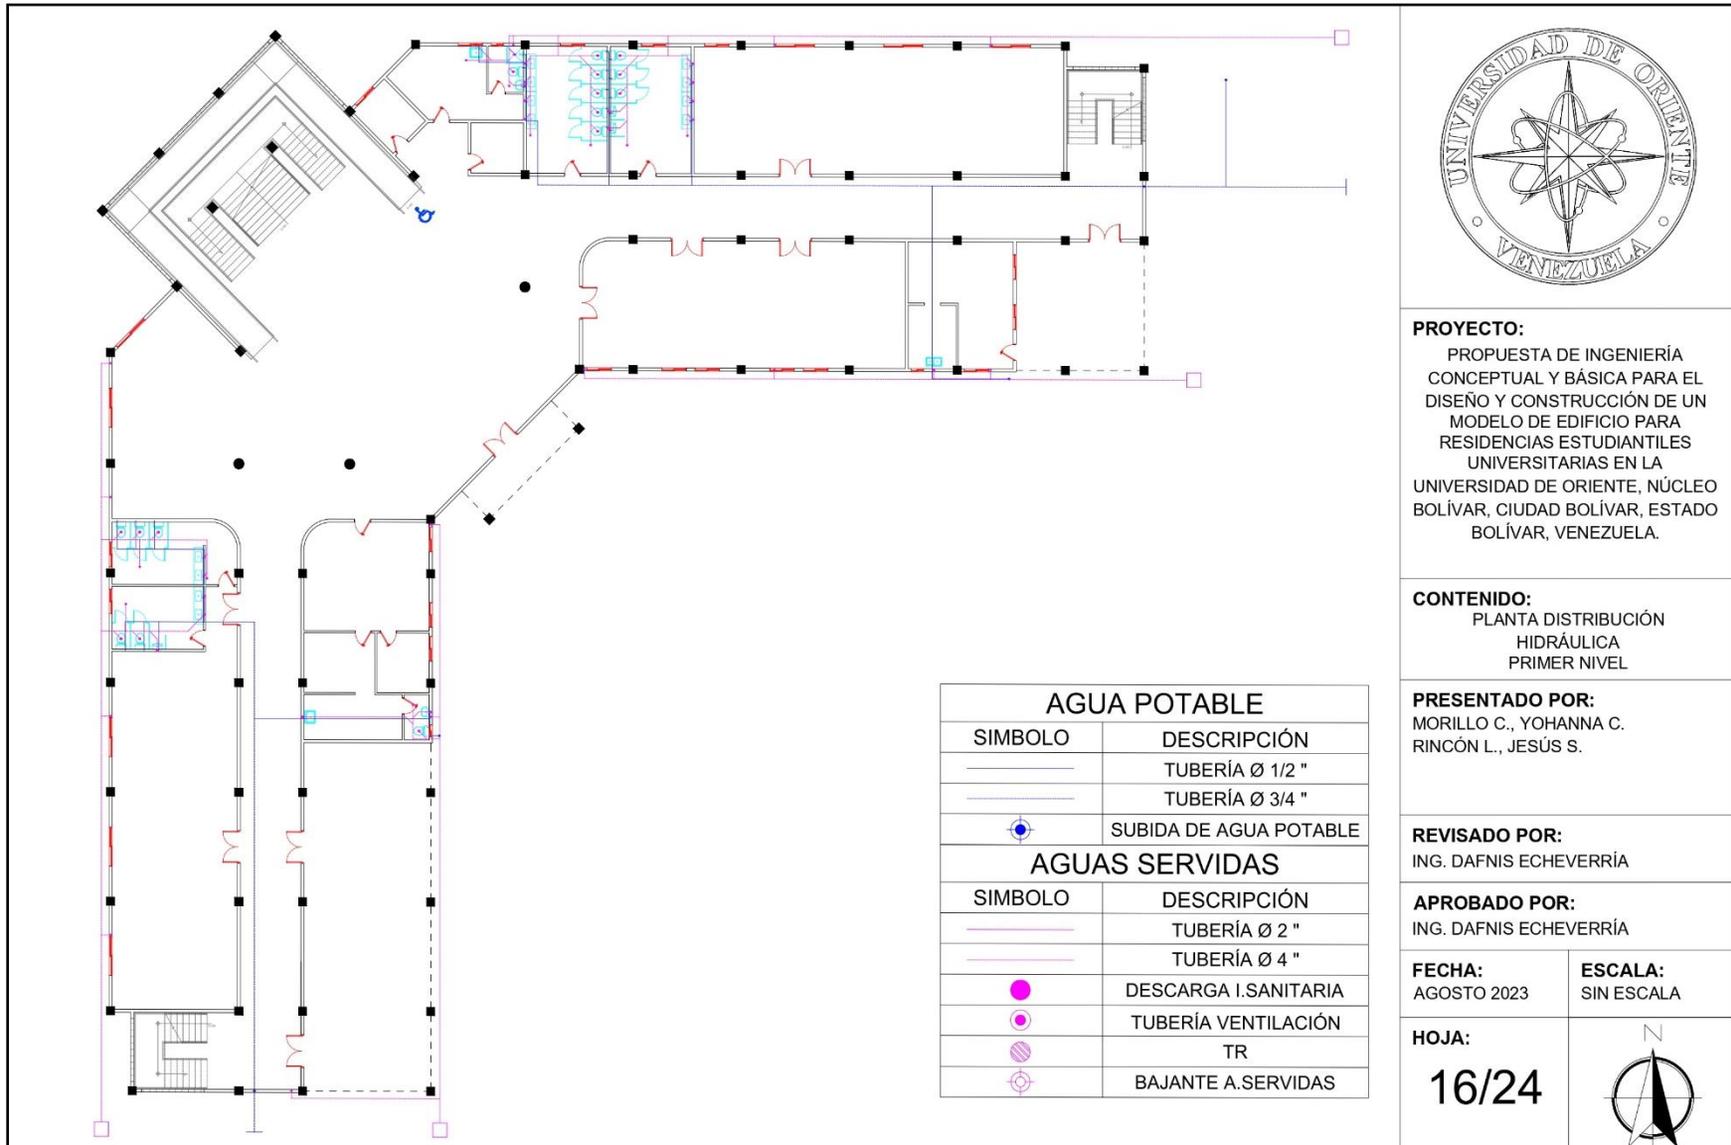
Plano de Planta. Distribución hidráulica, primer nivel.
